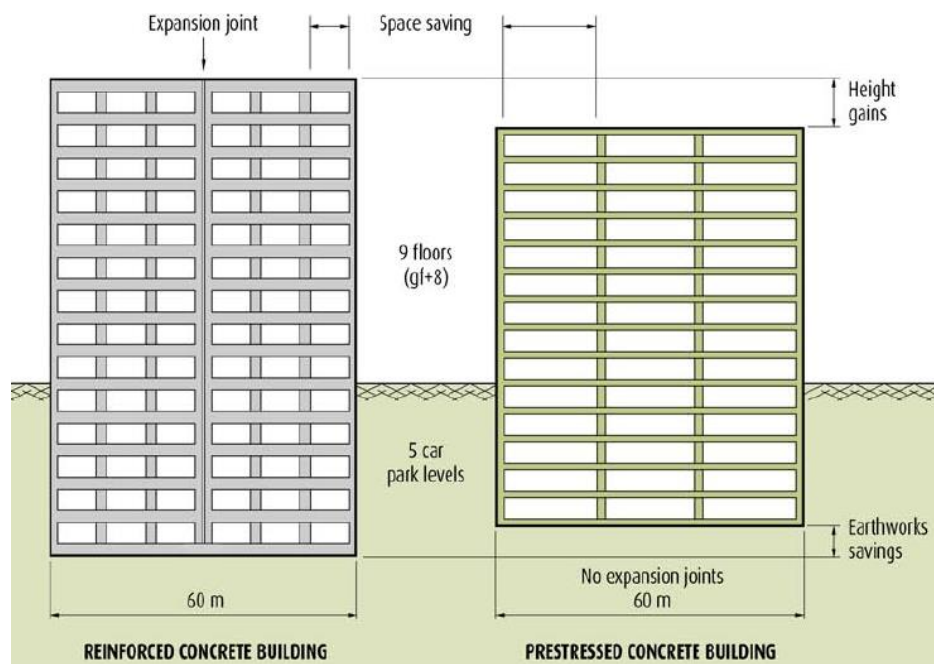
Vantagens de um edifício em betão armado pré-esforçado vs. betão armado convencional
